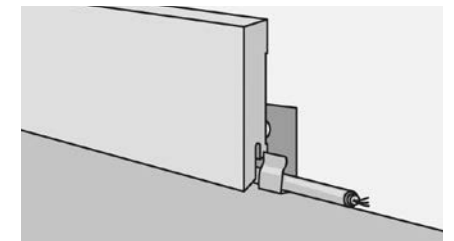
После укладки пола нужно вынуть фиксирующие клинья, а расширительные зазоры закрыть декоративным плинтусом. Плинтус крепится только к стене. Не допускается крепление плинтуса к напольному покрытию.
